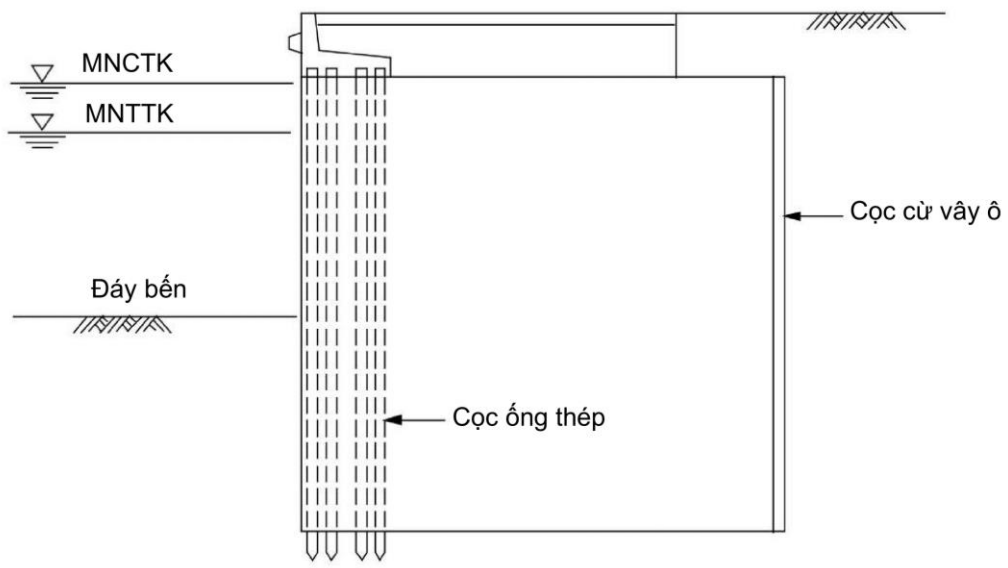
Kết cấu cừ có bản giảm tải như tường trọng lực
